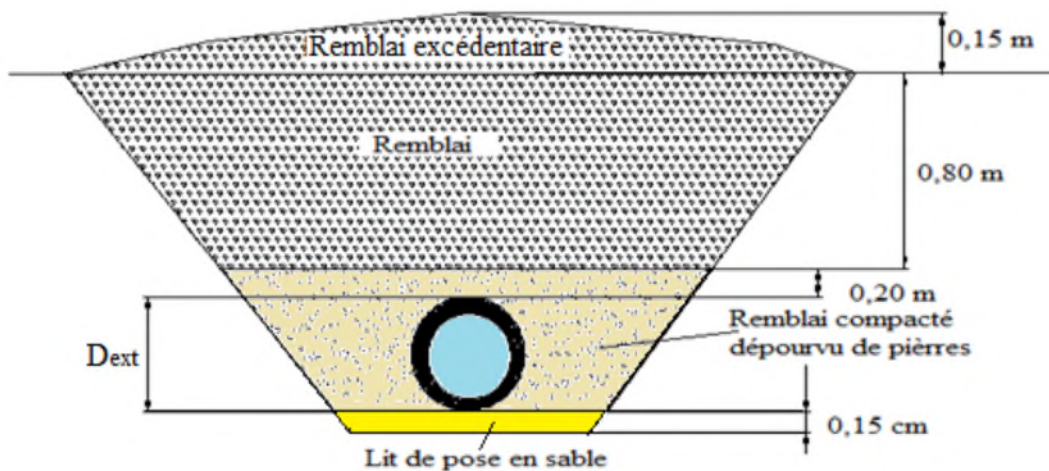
Coupe transversale d'une conduite enterrée
